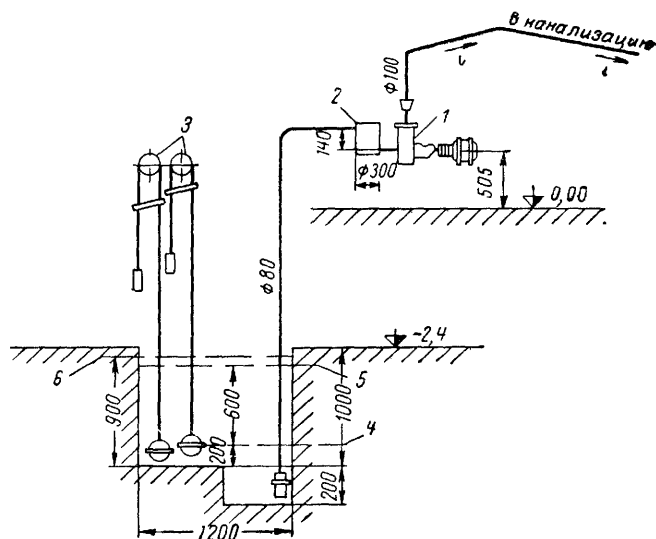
Схема дренажной насосной для дренажных помещений
